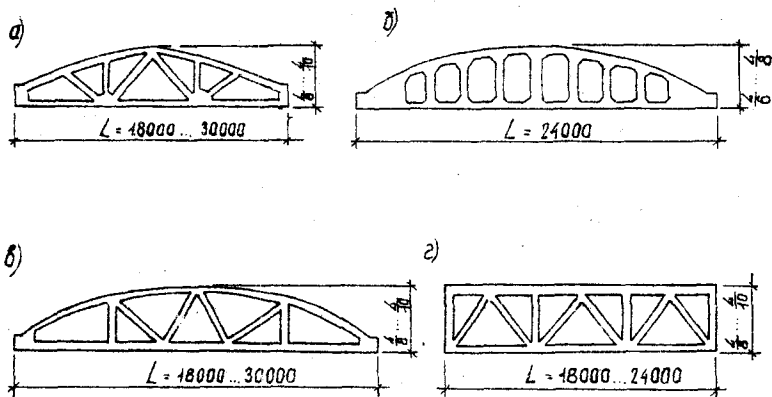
Стропильные фермы: а) сегментные раскосные; б) с криволинейным верхним поясом; в) раскосные арочные; г) раскосные с параллельными поясами
